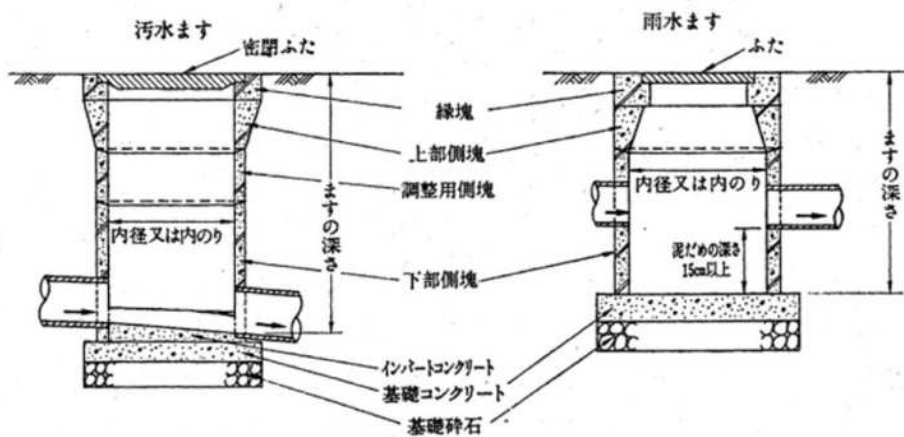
鉄筋コンクリート製のますの例（一部現場施工，既製ブロック使用）
